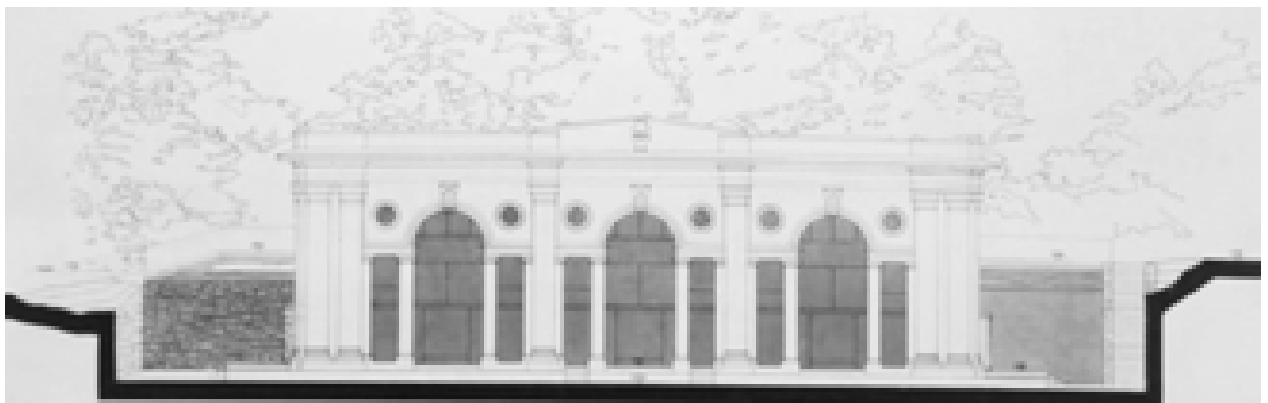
Prospetto Sud stato sovrapposto, progetto concessionato il 15/01/1985 (AABS-909)
